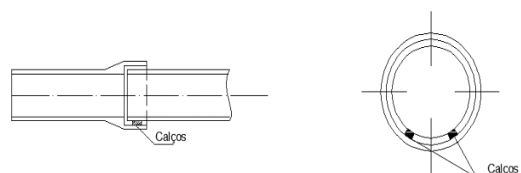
Pormenorização das campânulas de uma trincheira de infiltração (adaptada de Bartolomeu, 1996).
